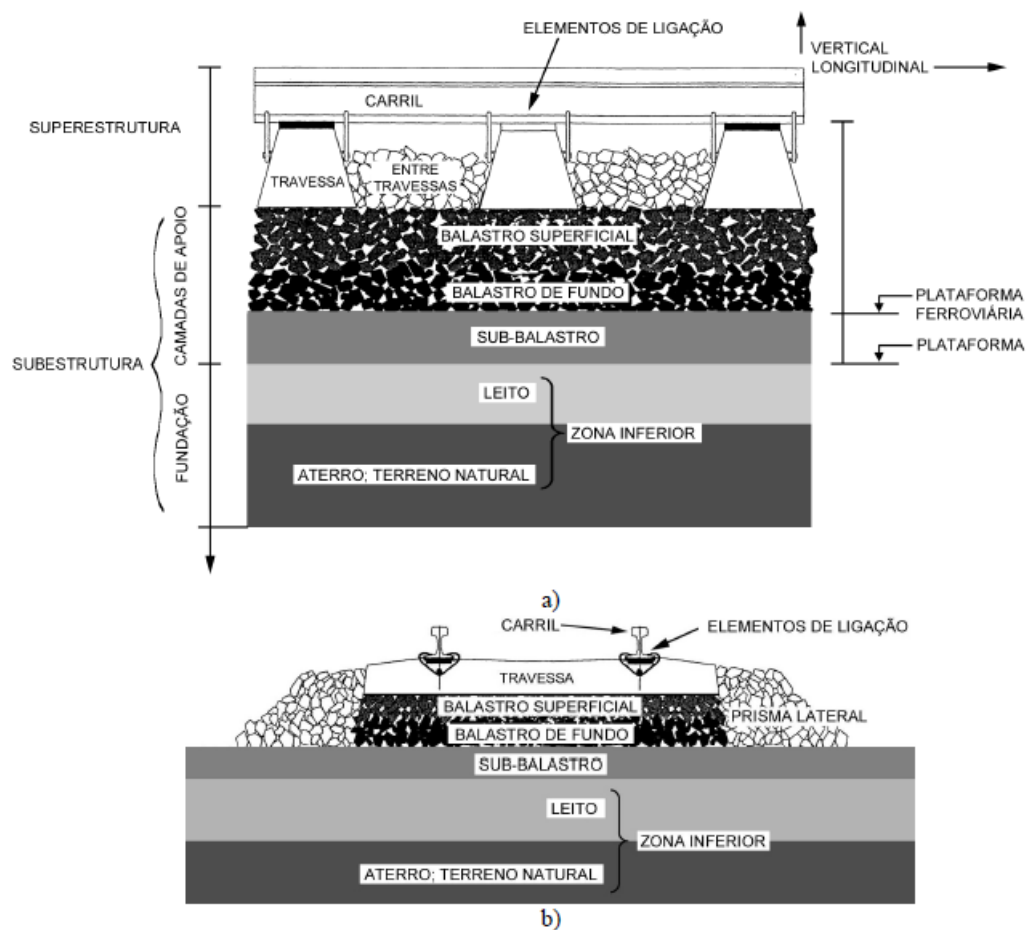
Esquema estrutural da via balastrada: a) Perfil Longitudinal; b) Perfil Transversal (adaptado de Fortunato, 2005)
